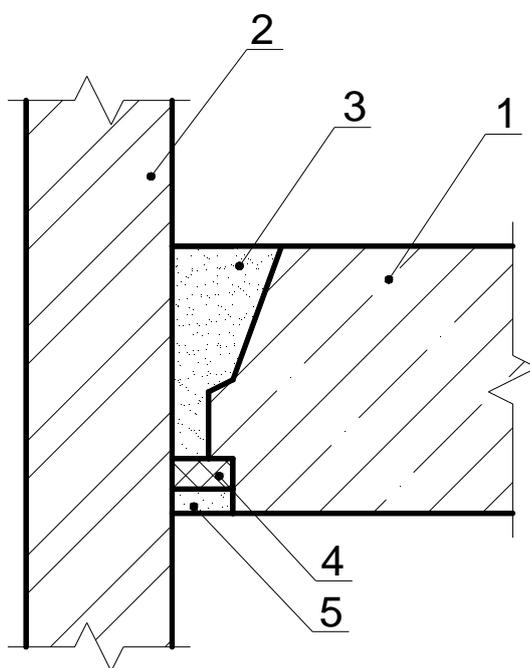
Схема конструктивного решения узла примыкания перекрытия к стене:
